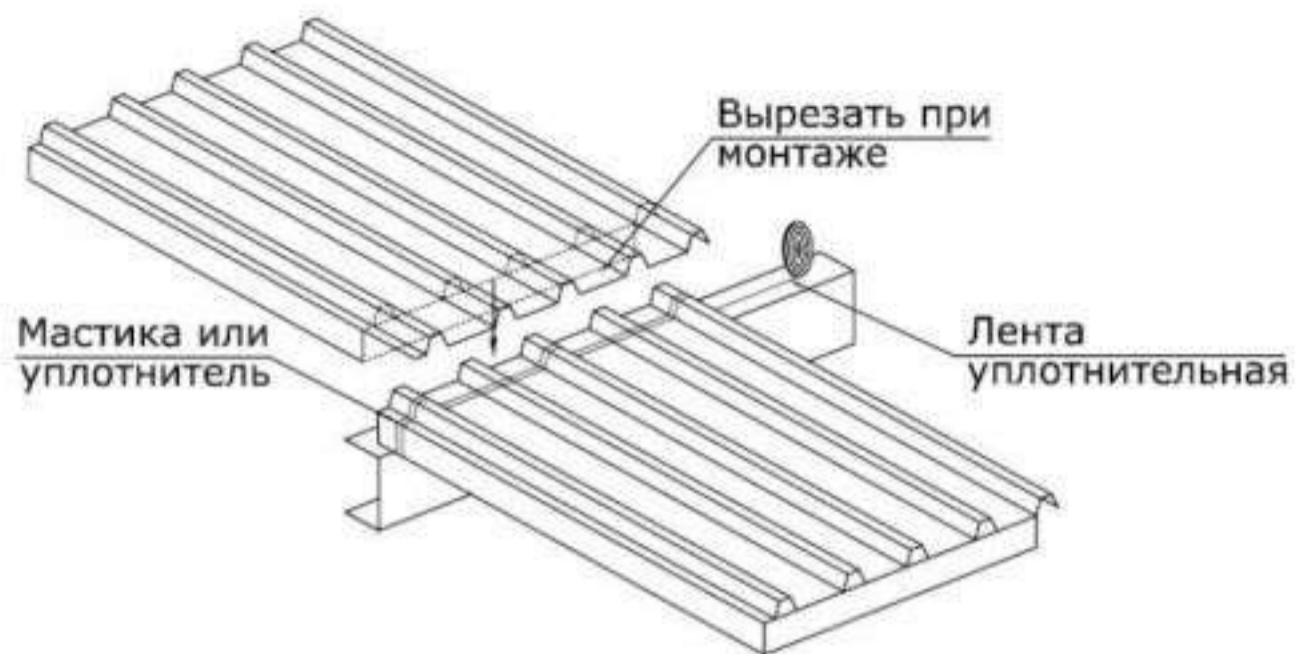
Монтаж кровельных панелей внахлест (начало монтажа)
